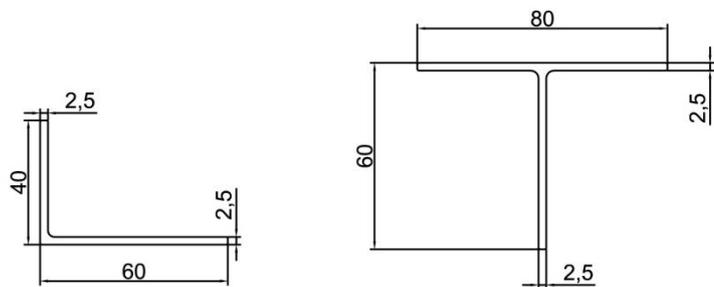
SISTEMA VISTO – ELEMENTOS DE FIJACIÓN
